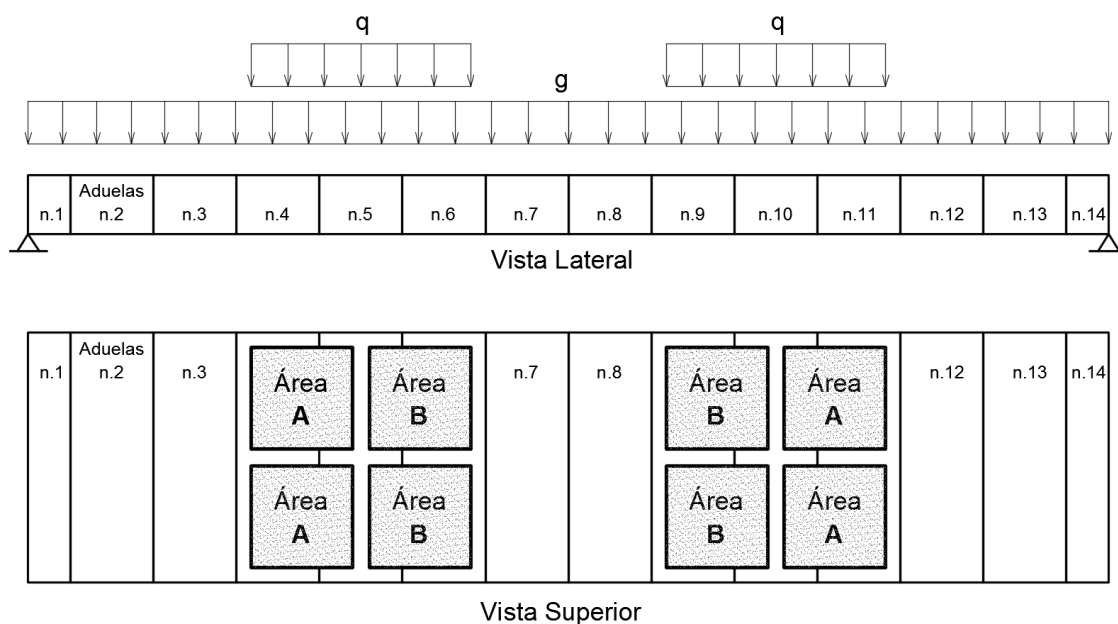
Ensaio em escala real em uma viga de ponte com aduelas pré-moldadas.
